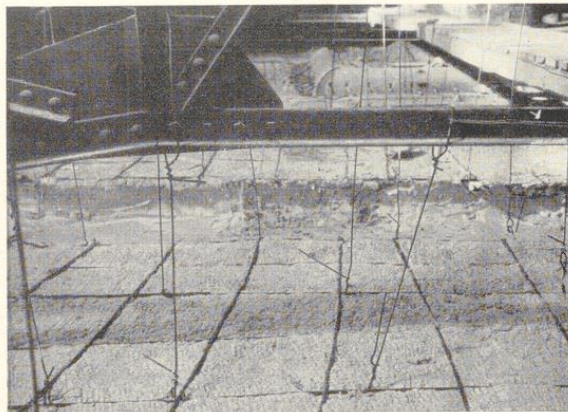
Abhängen einer Rabitzdecke an eiserner Dachkonstruktion
